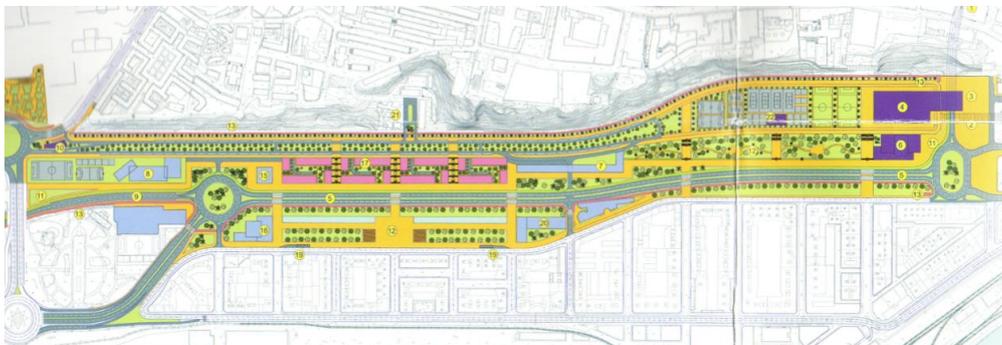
Planta de la propuesta del Plan General de Ordenación Urbana 2012.
